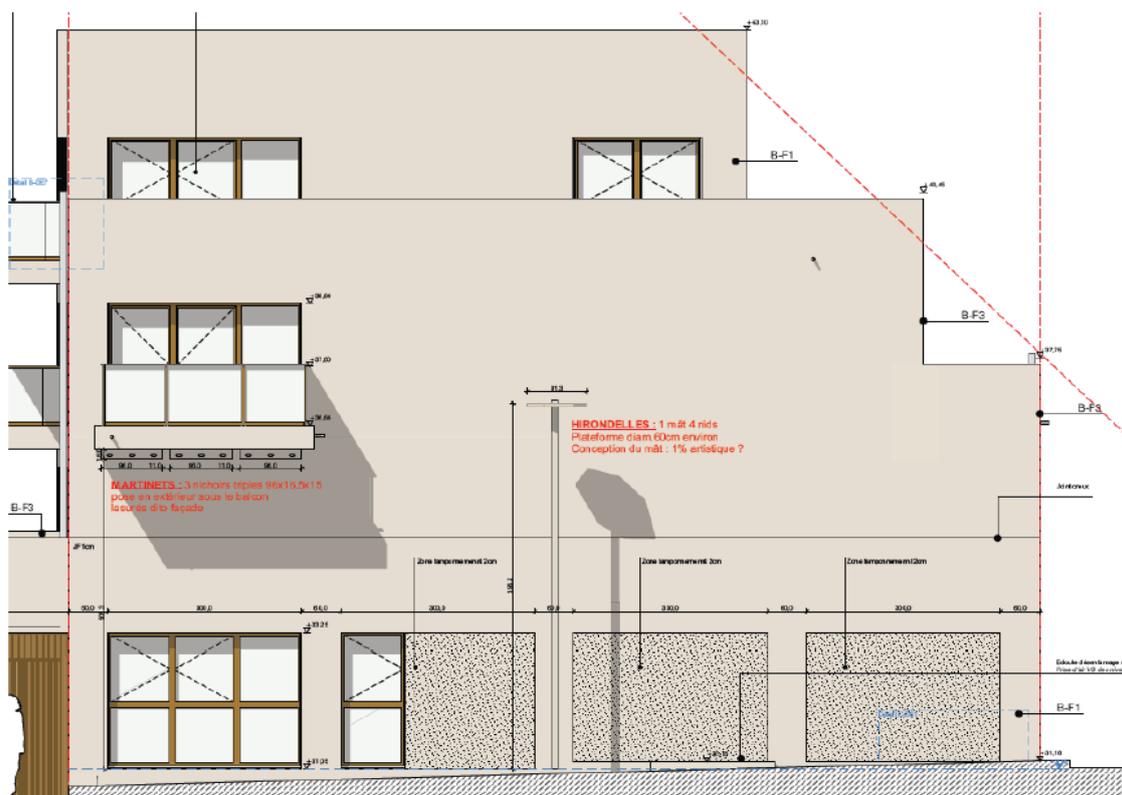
Zoom sur la localisation des nichoirs triples à martinet et du mat à hirondelles au sein de la façade est de la tranche 1 - Atelier 56S
